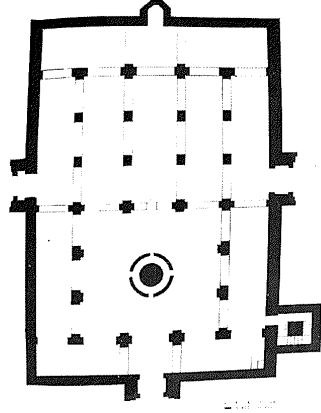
مسقط أفقي لجامع سيدي بلحسن
